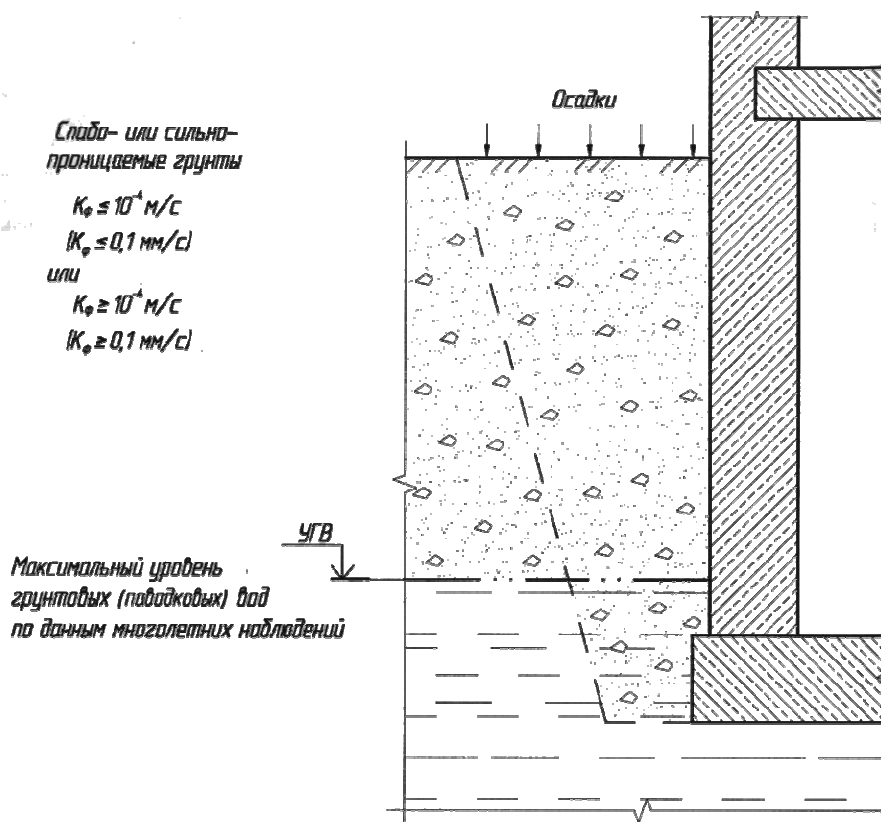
Расчётная схема нагрузки от воздействия грунтовой воды под давлением
